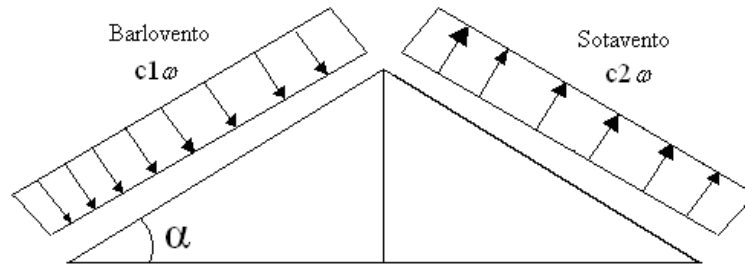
Barlovento y Sotavento, Elaboración Propia
